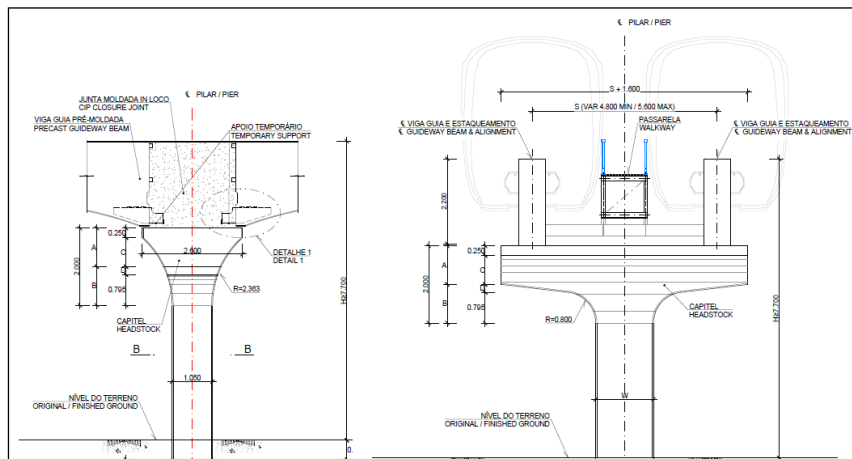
Forma Estrutura Via Elevada Tipo 1A (Planta DE-MG.00.EL\_C.EC2-002).
